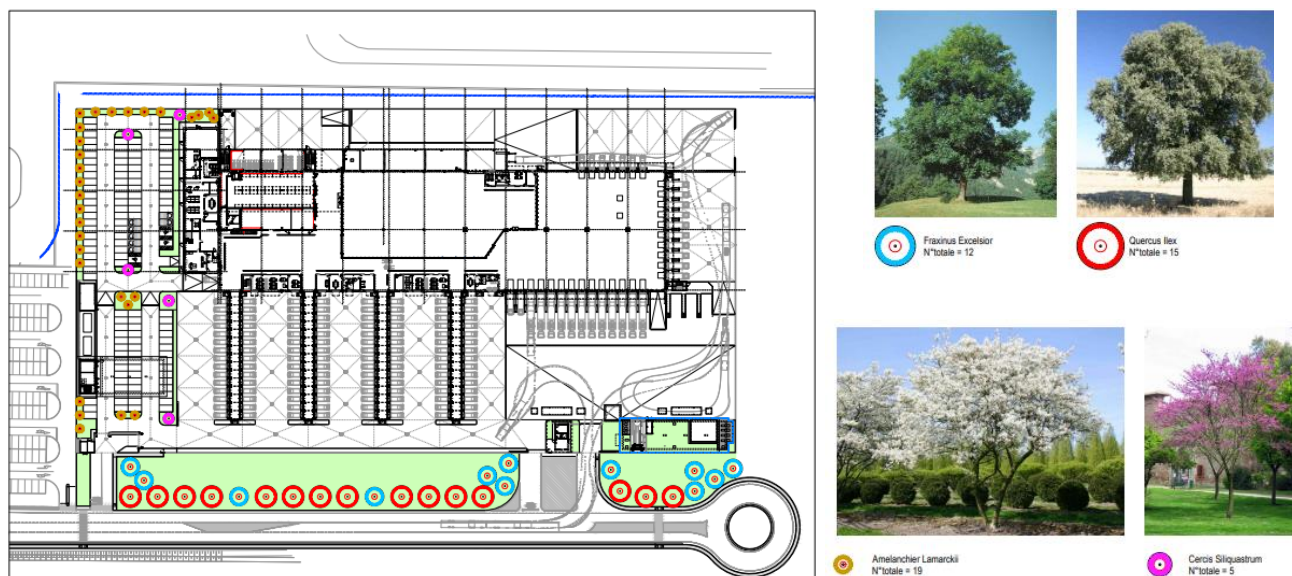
PLANIMETRIA GENERALE DELLE PIANTUMAZIONI – (elab.CO_G_02_210_002_00)
